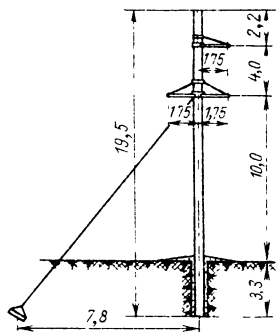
Железобетонная анкерная угловая одноцепная опора на оттяжках ВЛ 35 кВ
